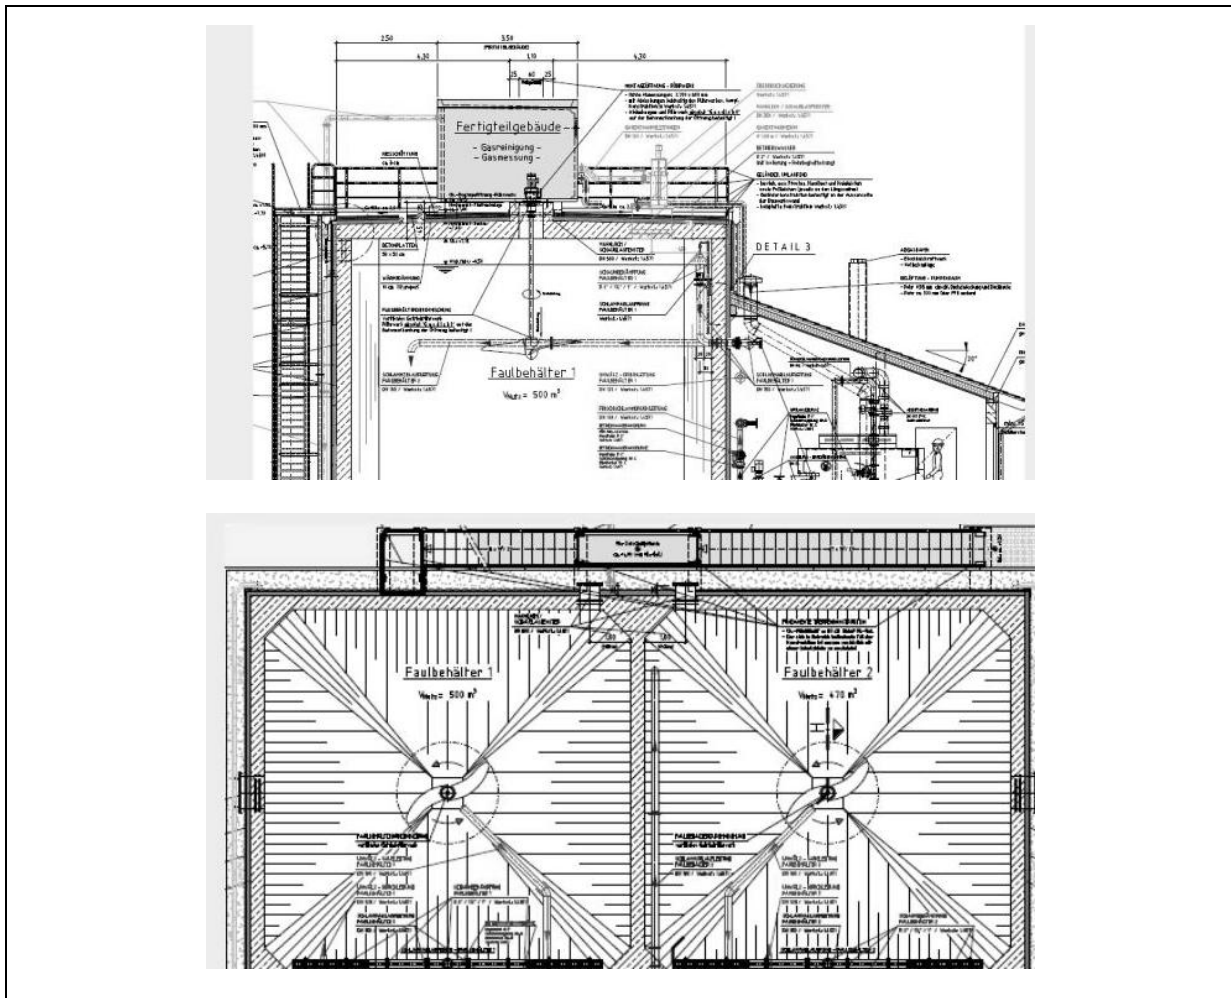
Grundriss und Schnitt eines 2-stufigen Kompaktfaulbehälters
